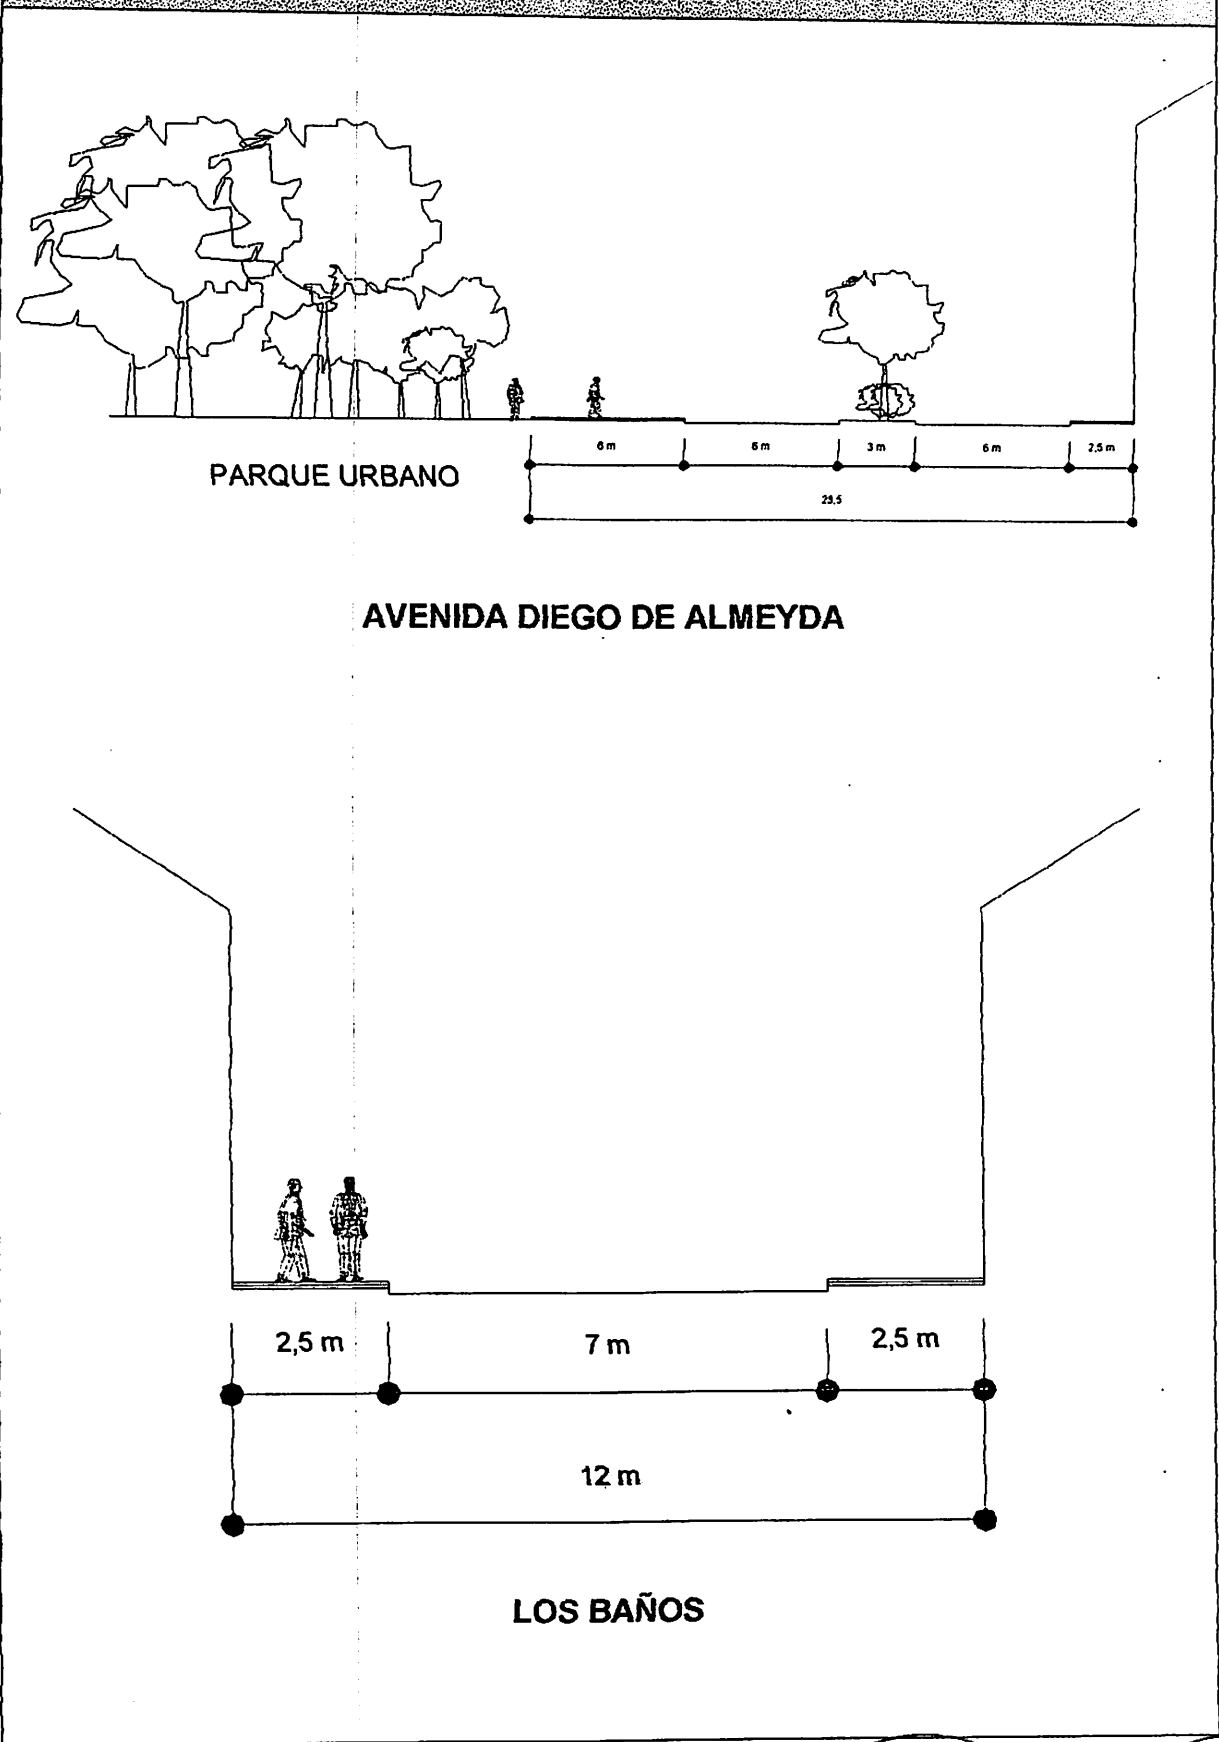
FIGURA VI. PERFILES DE CALLES Y AVENIDAS
